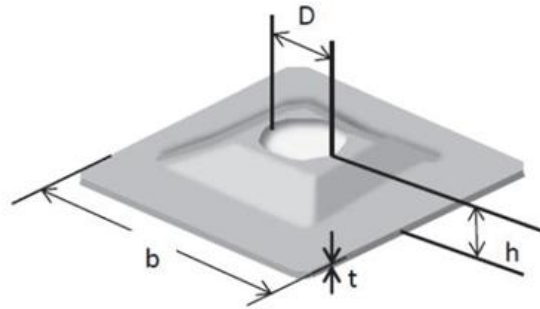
Detalhe das dimensões da chapa utilizada no sistema de atirantamento
